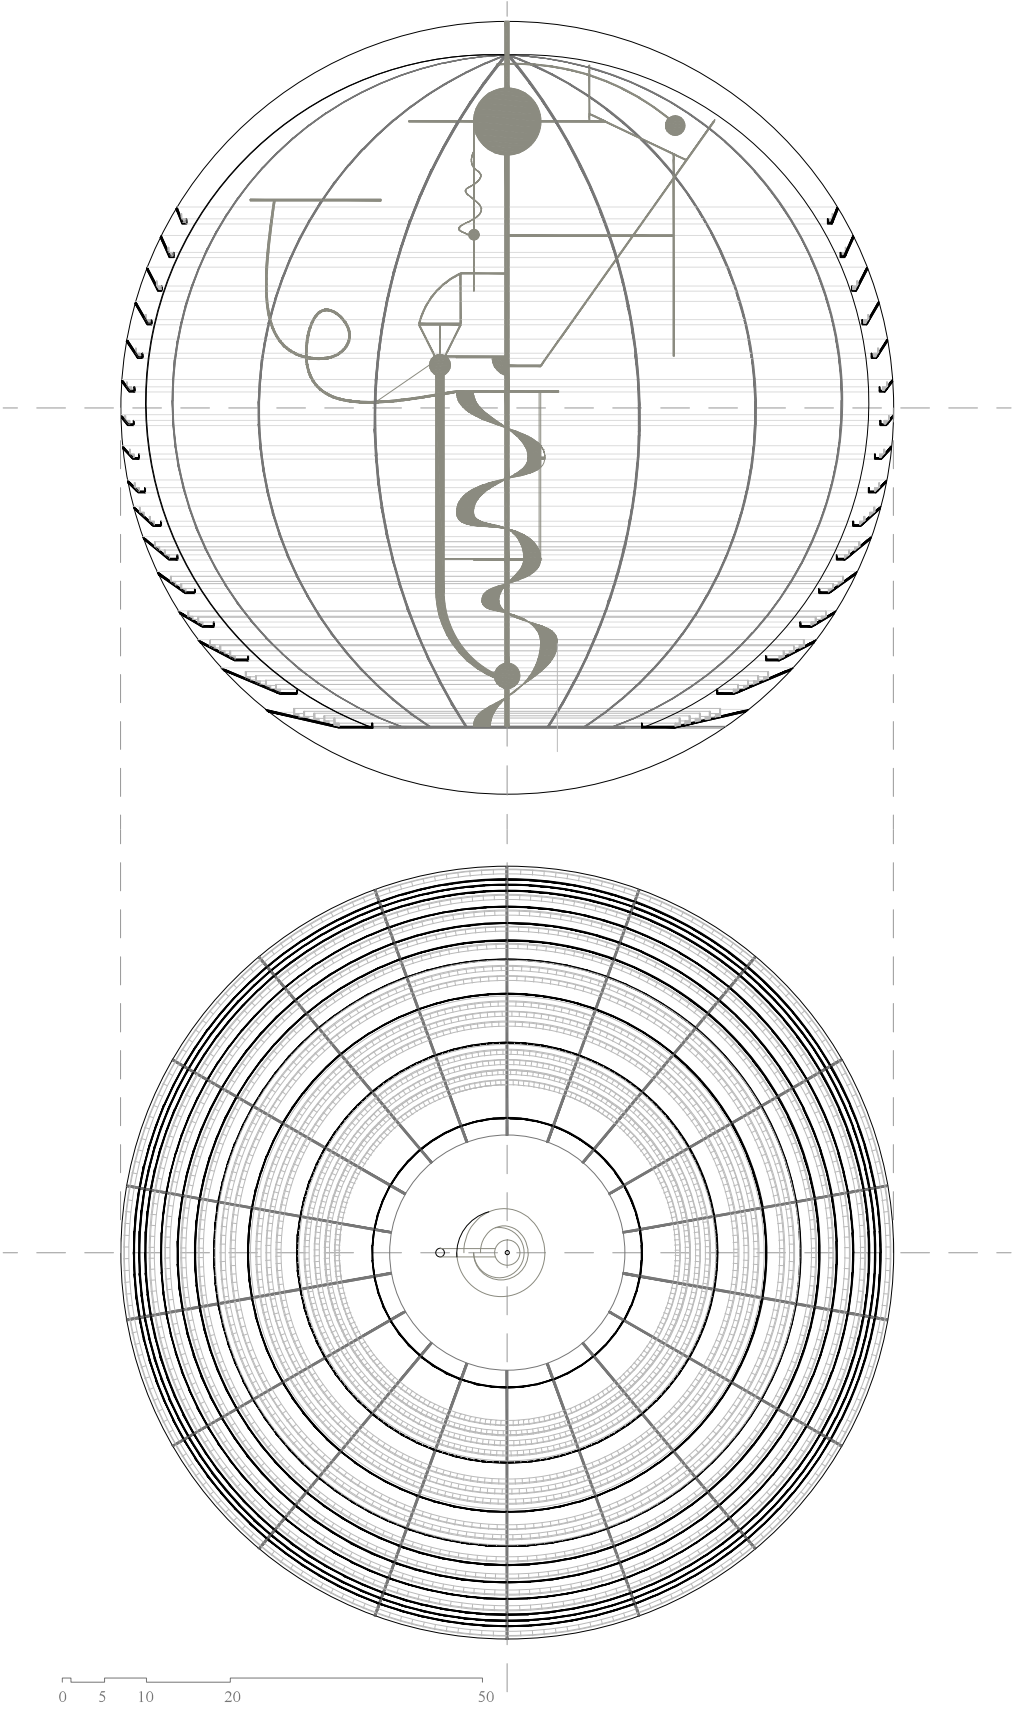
Planimetría. Sección y planta. Elaboración propia.
